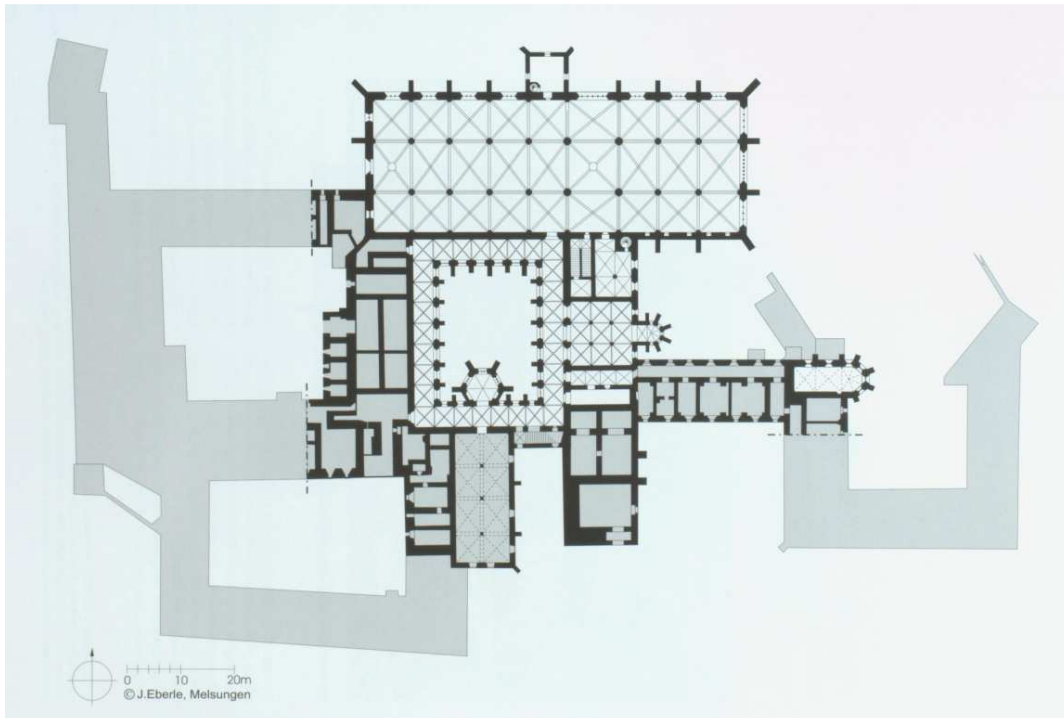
Stift Neuberg an der Mürz, Grundriss, Jürgen Eberle
